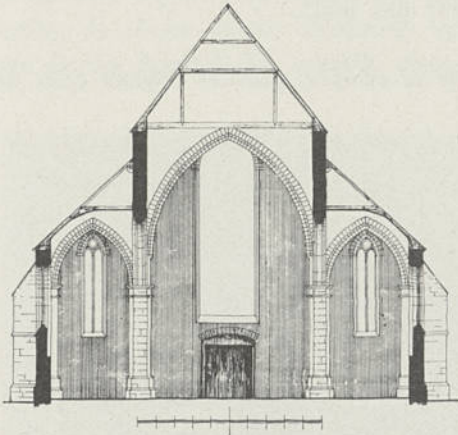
Diest, Eglise du Béguinage, coupe transversale, reconstitution
